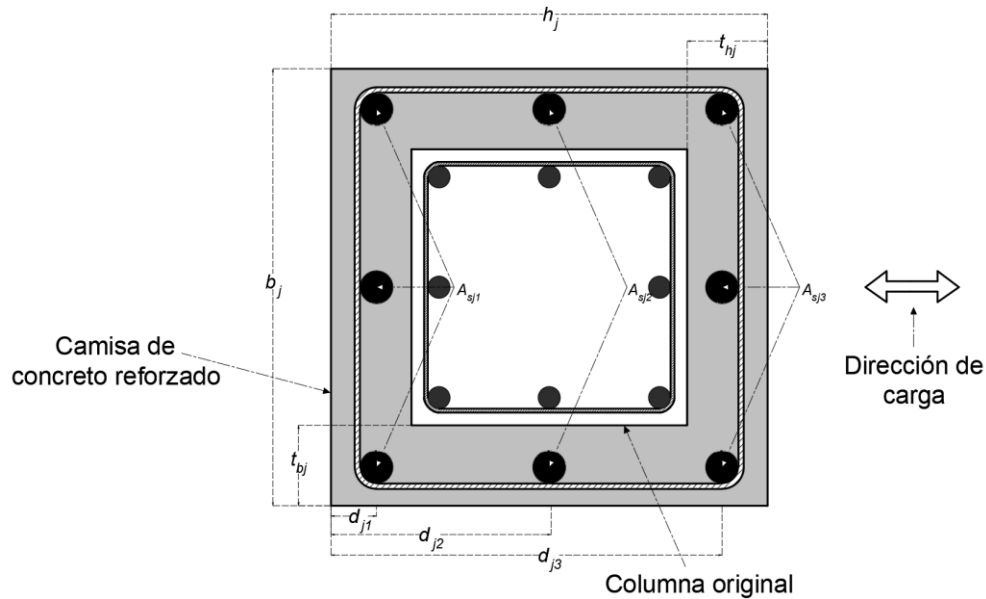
Configuración de la sección transversal de columna encamisada con concreto reforzado con barras de acero
